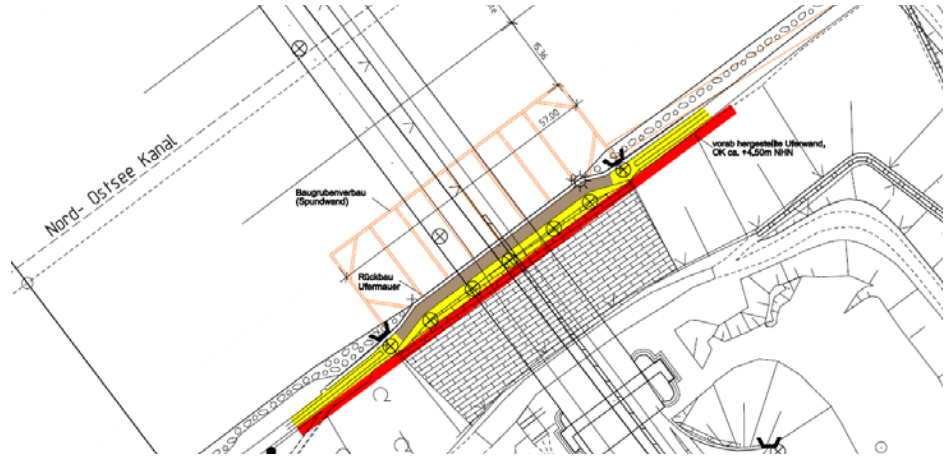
Rückbau Notfundamentreste in trockener Baugrube (Grundriss)
